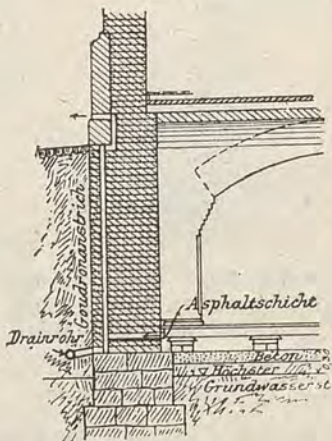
Protezione dei muri da cantina contro l'umidità.
